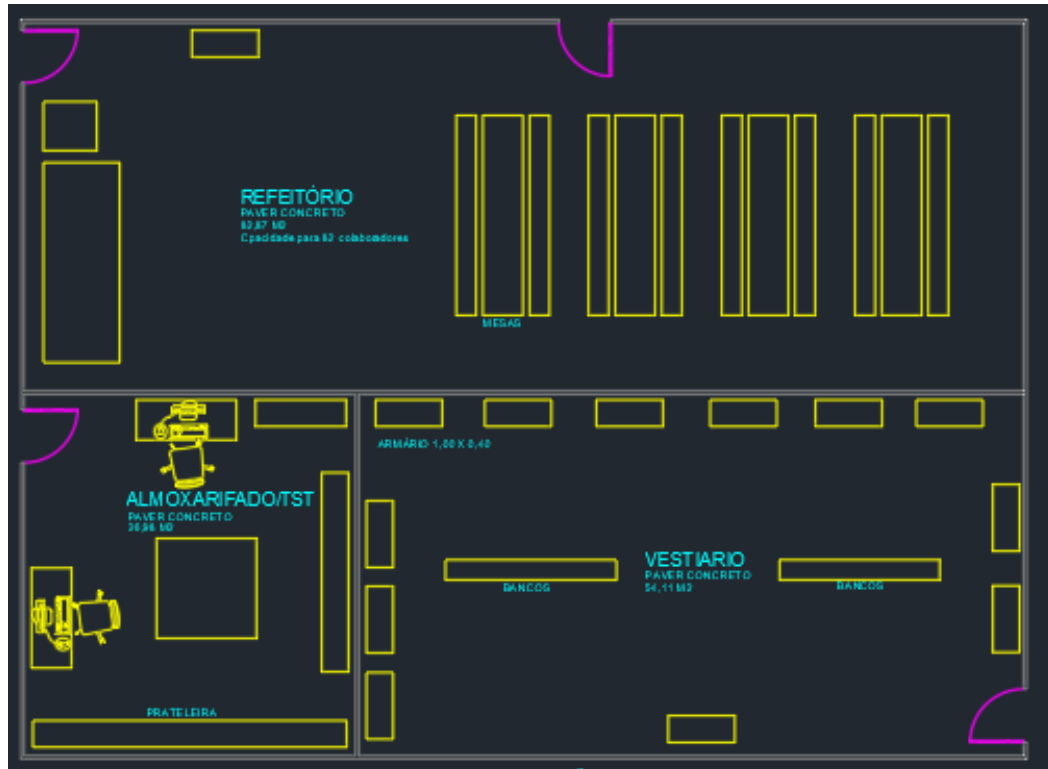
Planta baixa do primeiro almoxarifado, junto com TST e engenharia.
